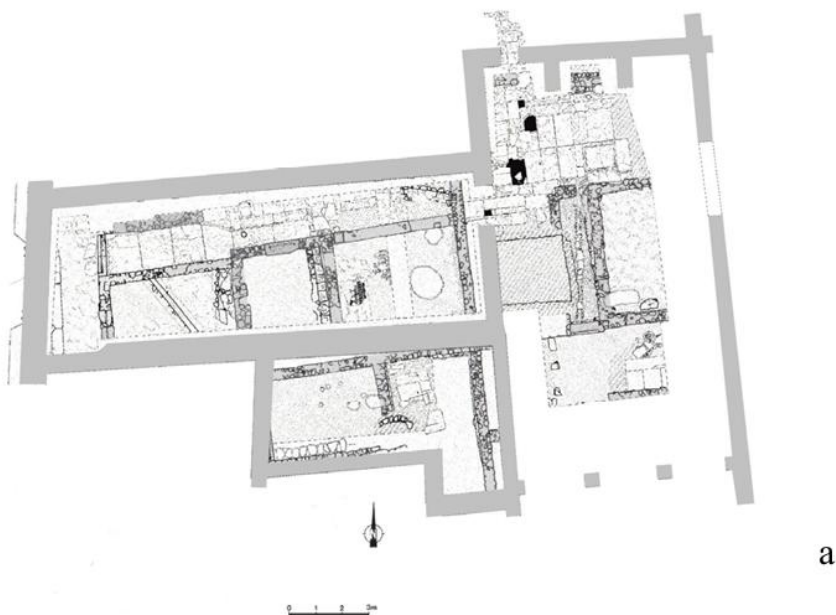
Palazzo Tabarelli: planimetria degli scavi. a: strutture e ambienti della fase imperiale (da CAVADA, PAVONI 2008, p. 448).
